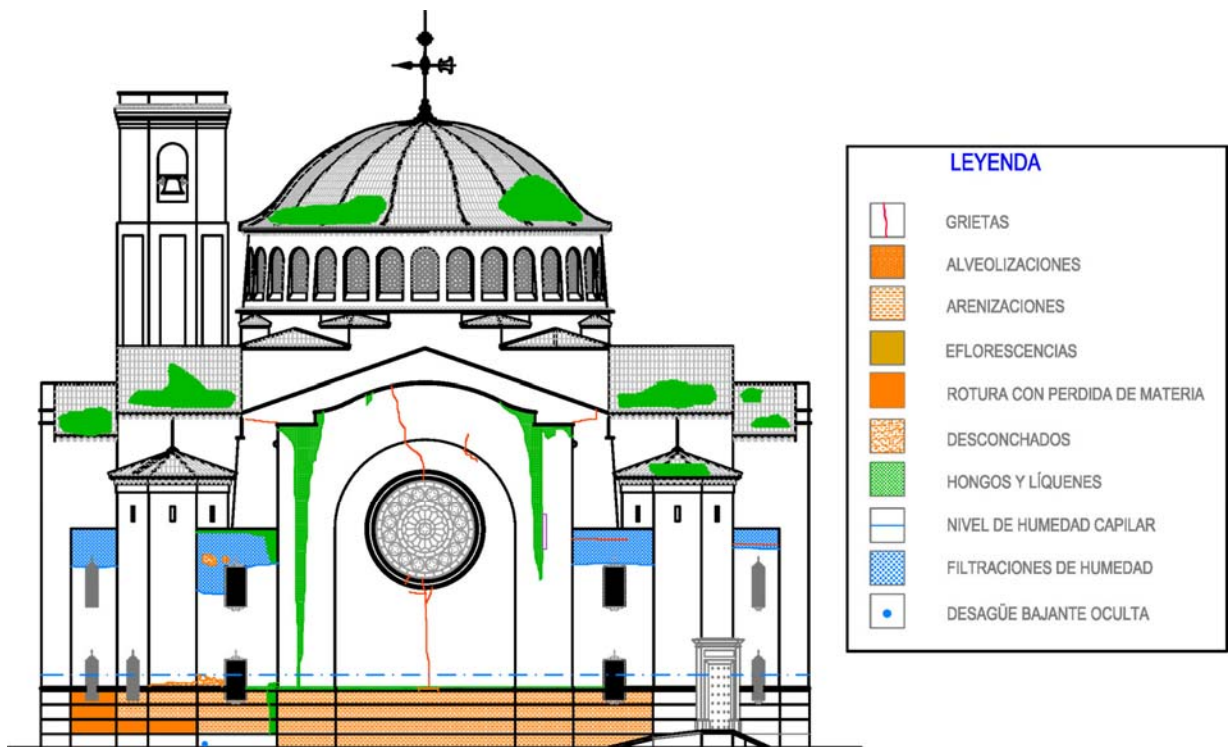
Plano de lesiones, fachada posterior con orientación Norte.
